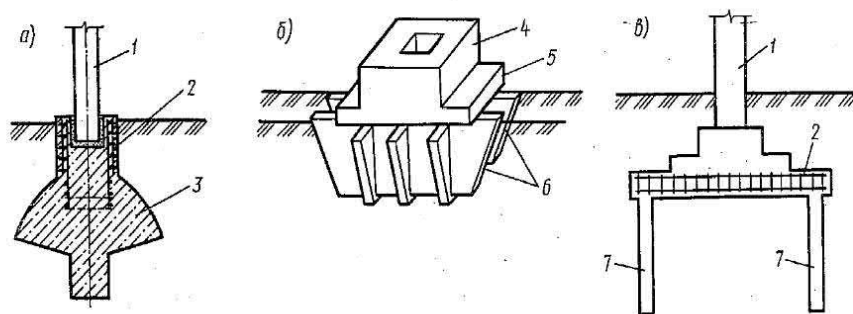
Буробетонные (а), щелевые (б) и анкерные (в) фундаменты:
